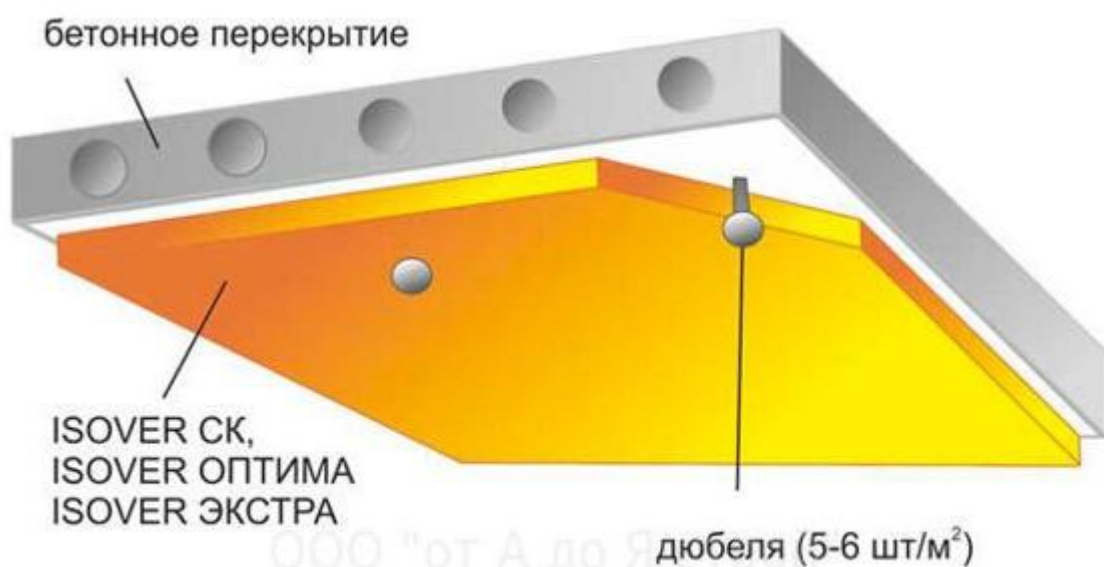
Утепление существующего цокольного перекрытия
